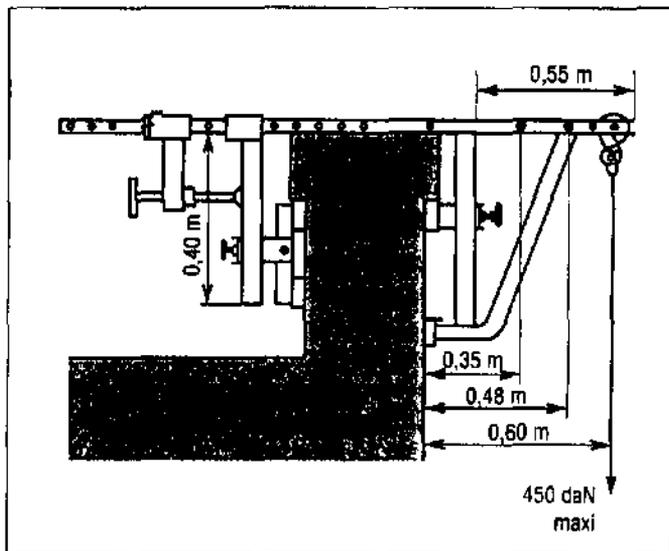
Accrochage d'un échafaudage volant sur acrotère.
